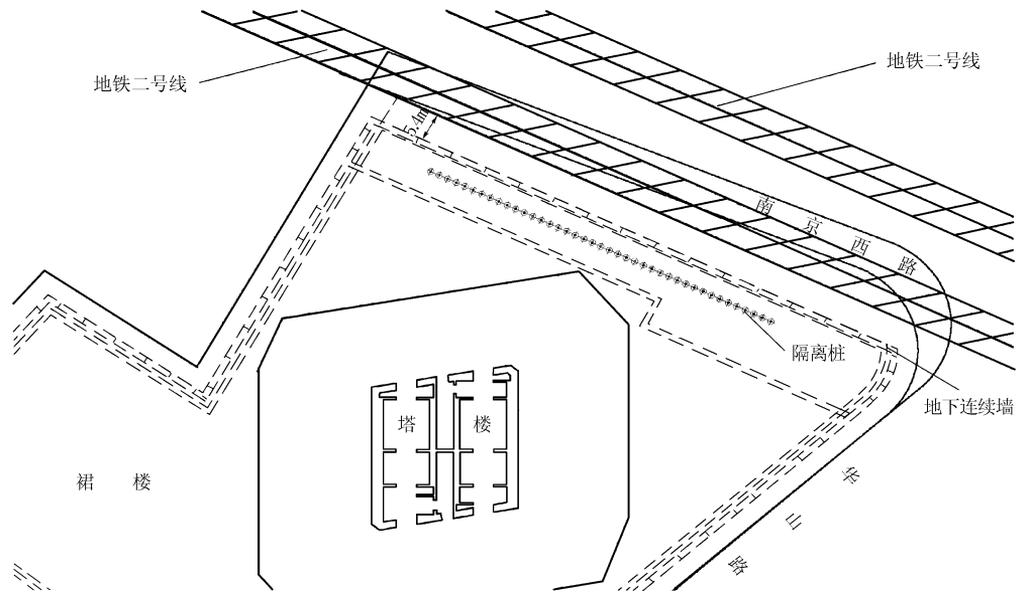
上海会德丰广场基坑隔离桩及其周边环境平面图
